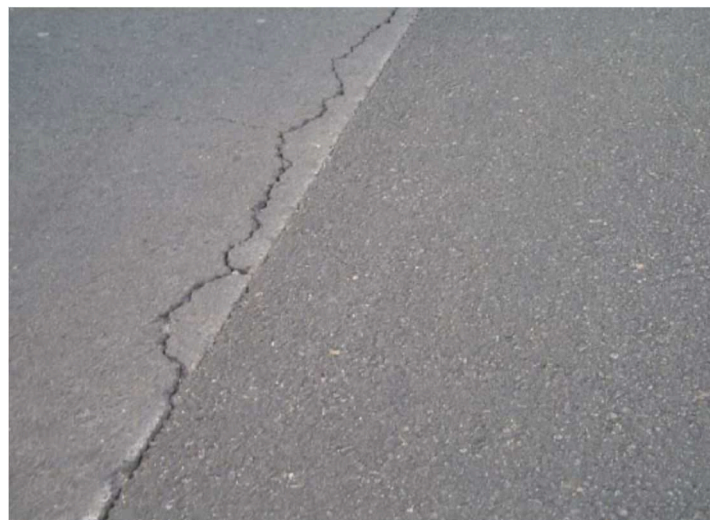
Présence des fissures sur la chaussée dans la zone adjacente à la tranchée (*Nichols Consulting Engineers 2007*)
